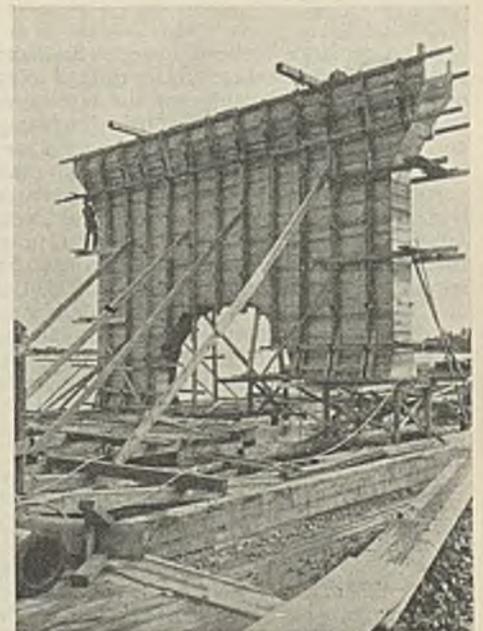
Kaianlage bei Wallvik. Schalung einer Scheibe.
